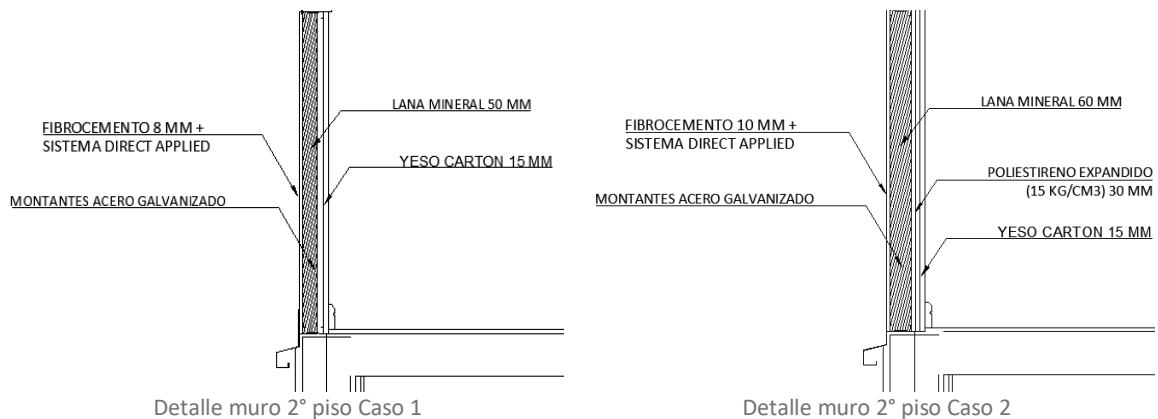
Detalles constructivos de la envolvente térmica del muro del 2° piso para ambos casos de estudio.
